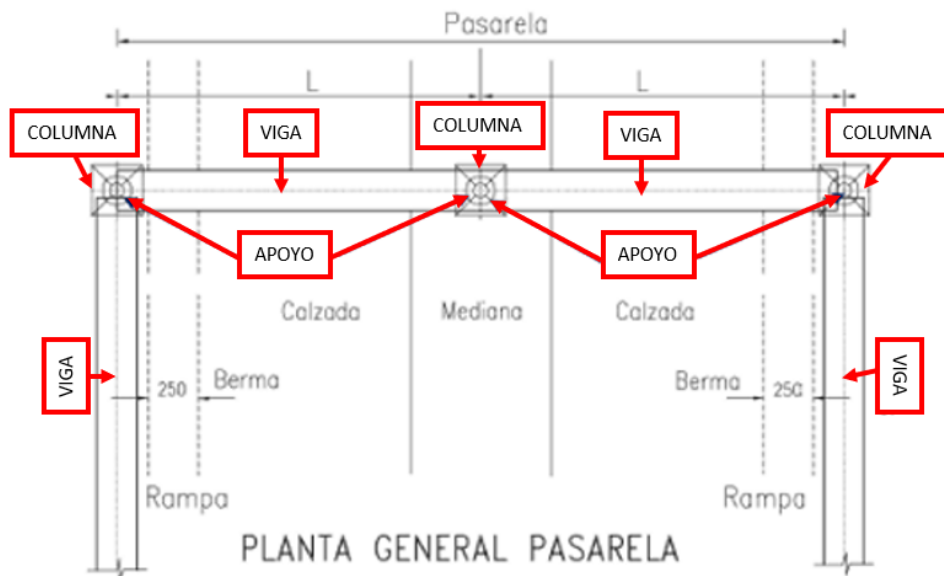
Vista en planta de pasarela peatonal y sus elementos estructurales a valorizar.
